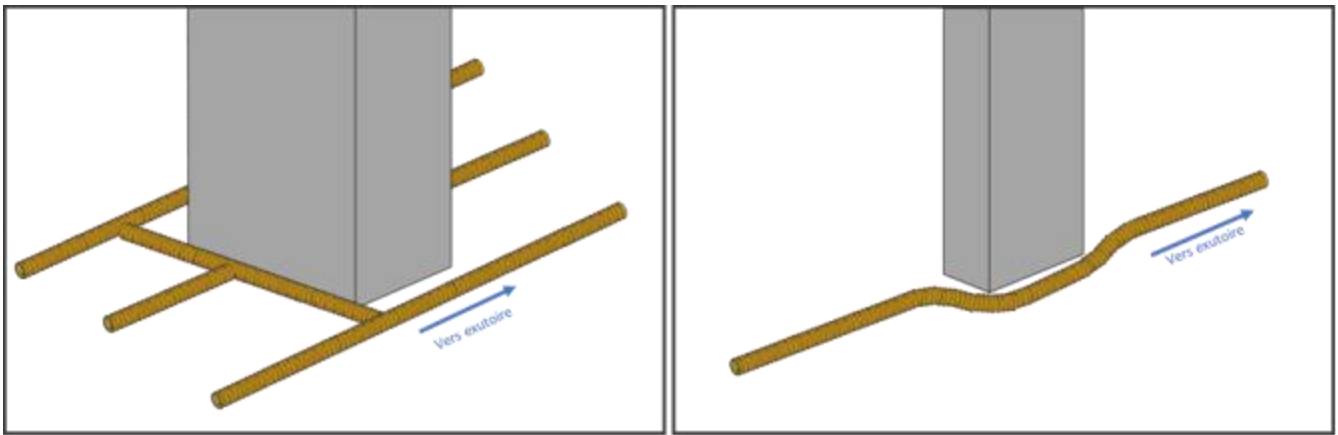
Raccordement DRAINTUBE® FTB / tranchée drainante
